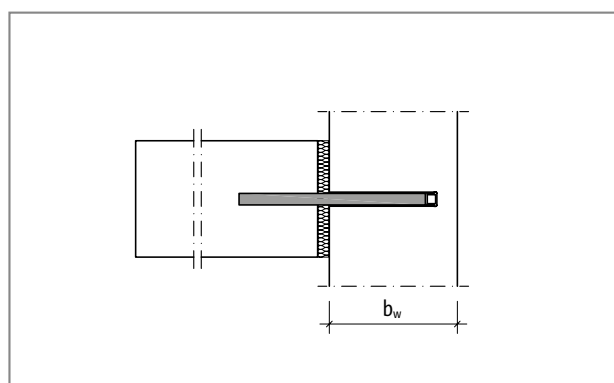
Schöck perno tipo LD: spessore minimo dell'elemento di una parete o di un pilastro
